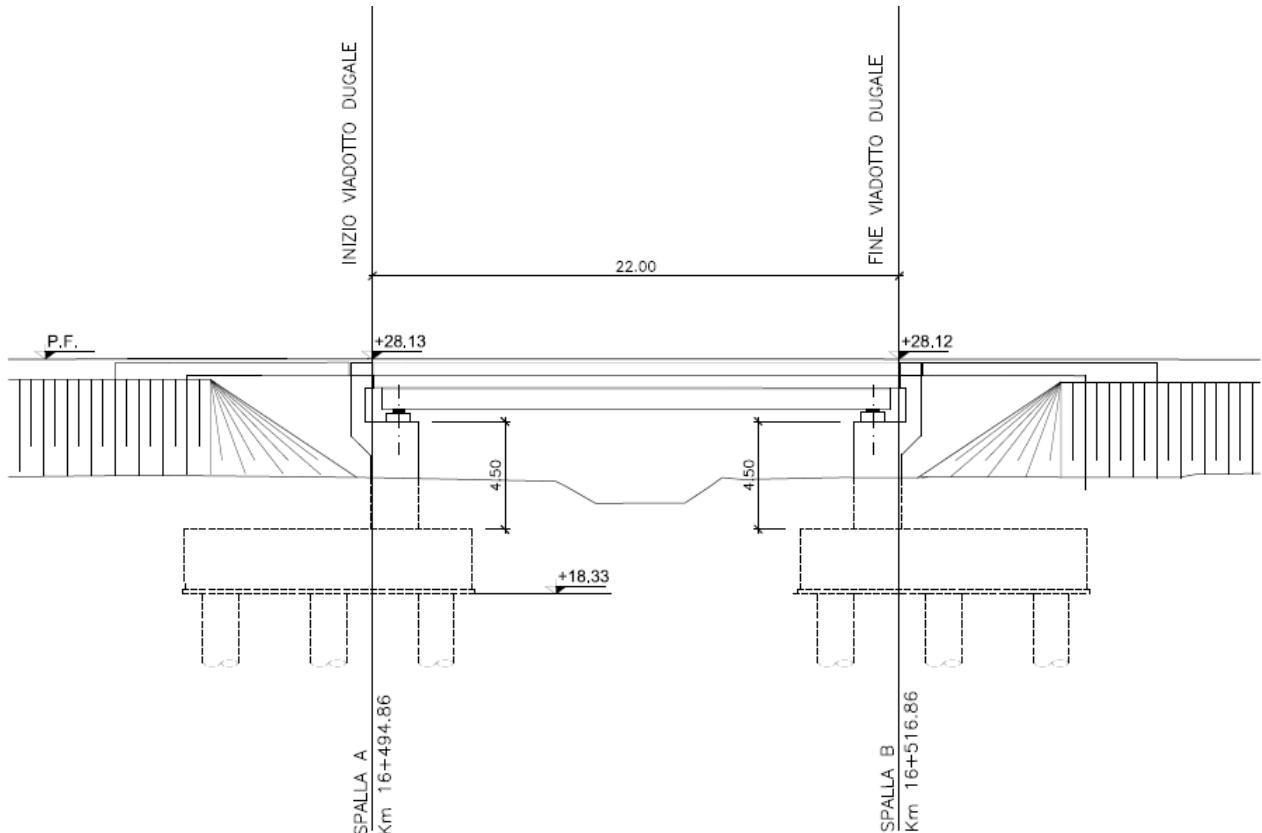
Sezione longitudinale ponte “Dugale 2”.
